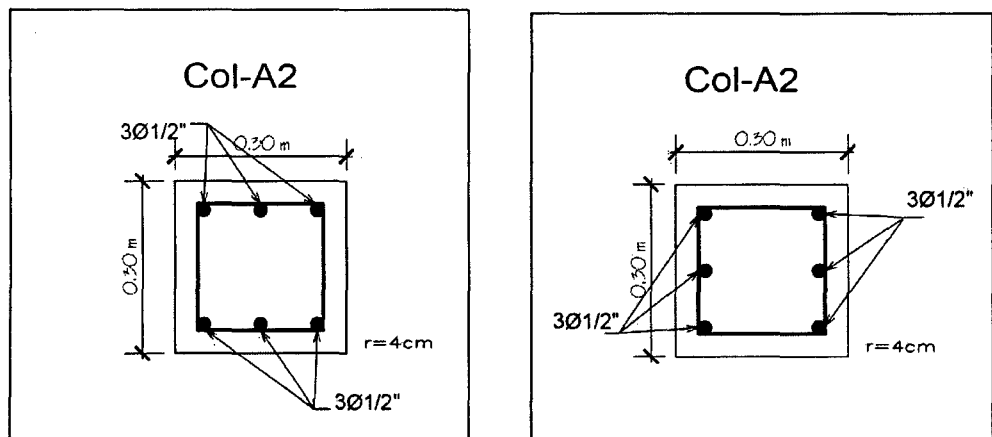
Distribución de refuerzo en cada uno de los lados de la columna A2.
